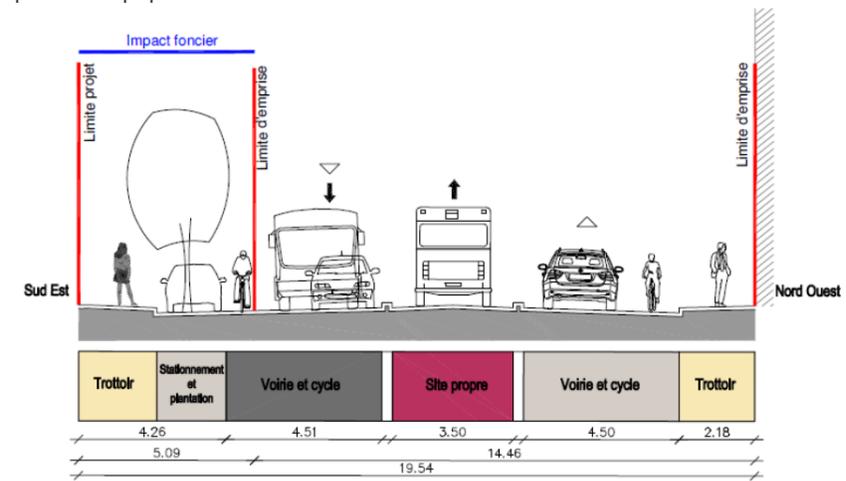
Coupe type en section courante sur la rue Danielle Casanova
